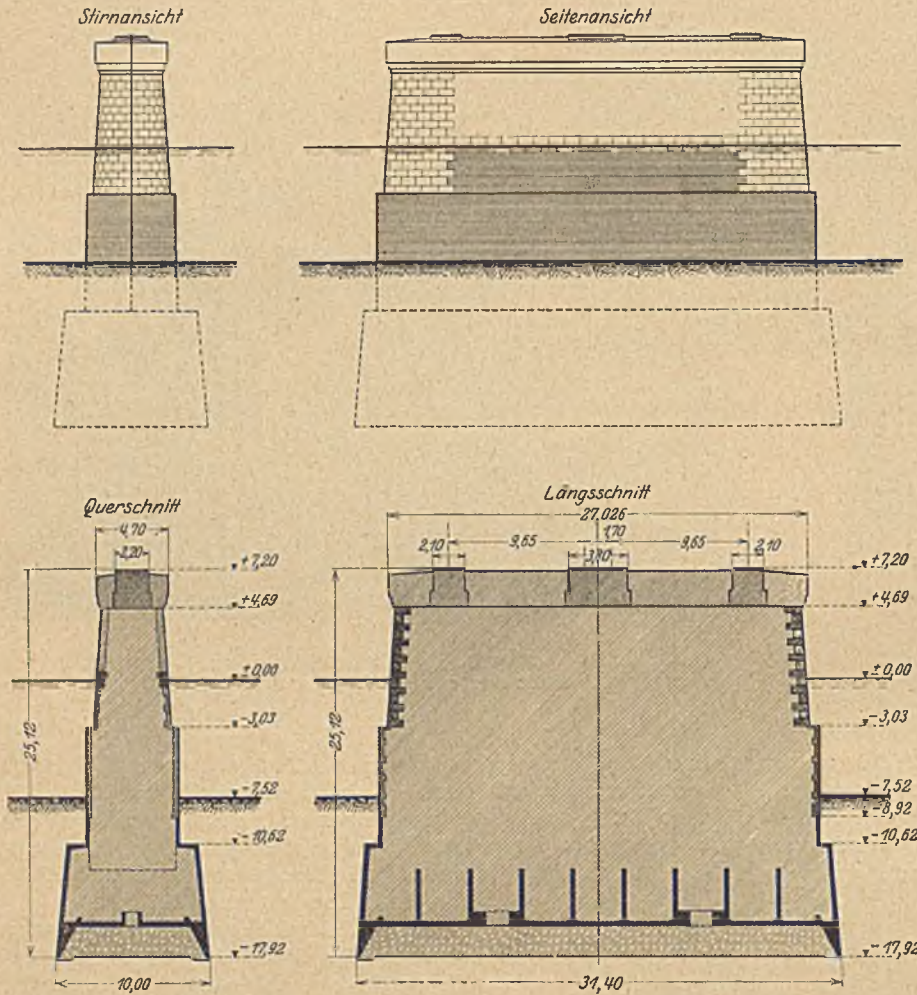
Ostoderbrücke Stettin. Querschnitt und Längsschnitt der Strompfeiler.
